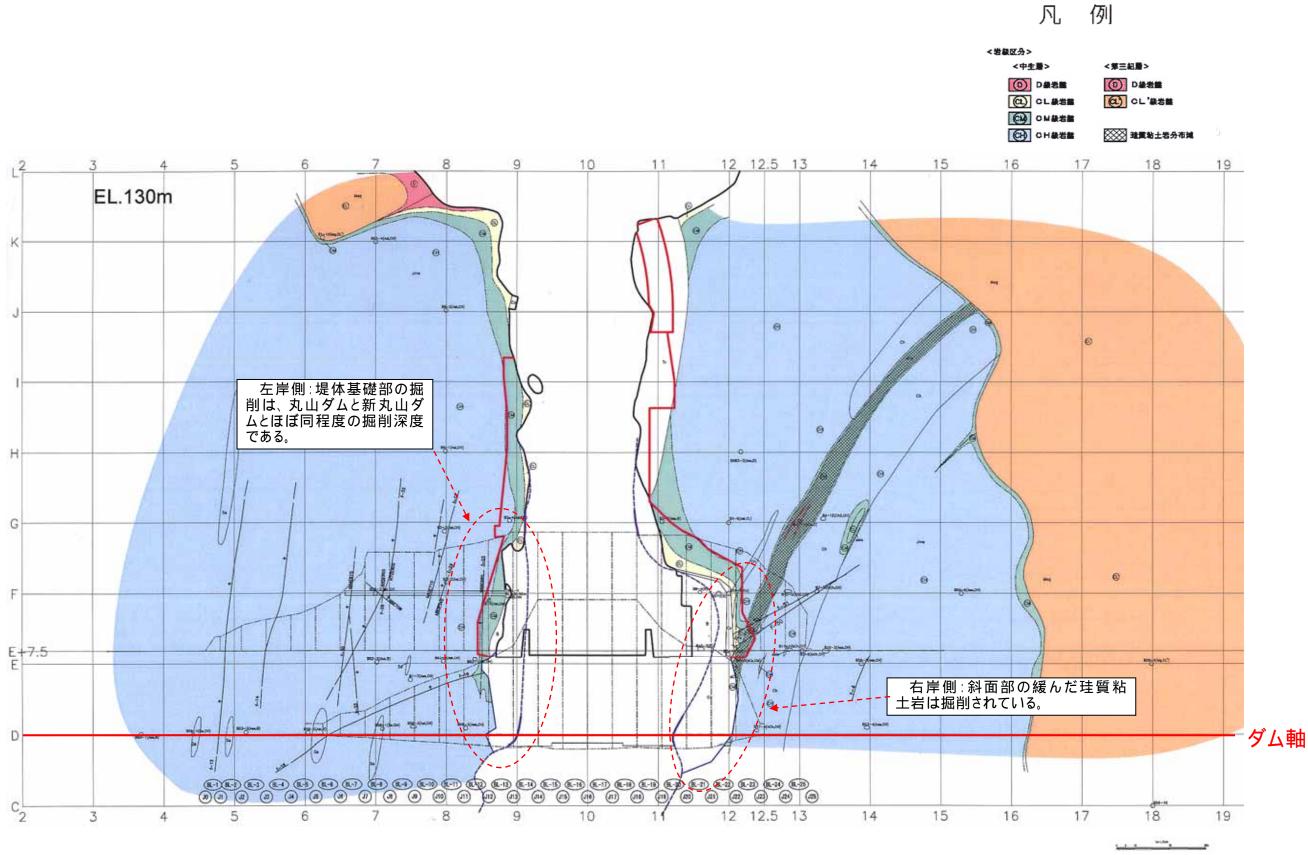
丸山ダムの基礎岩盤の状況(EL.130m 水平断面図)
